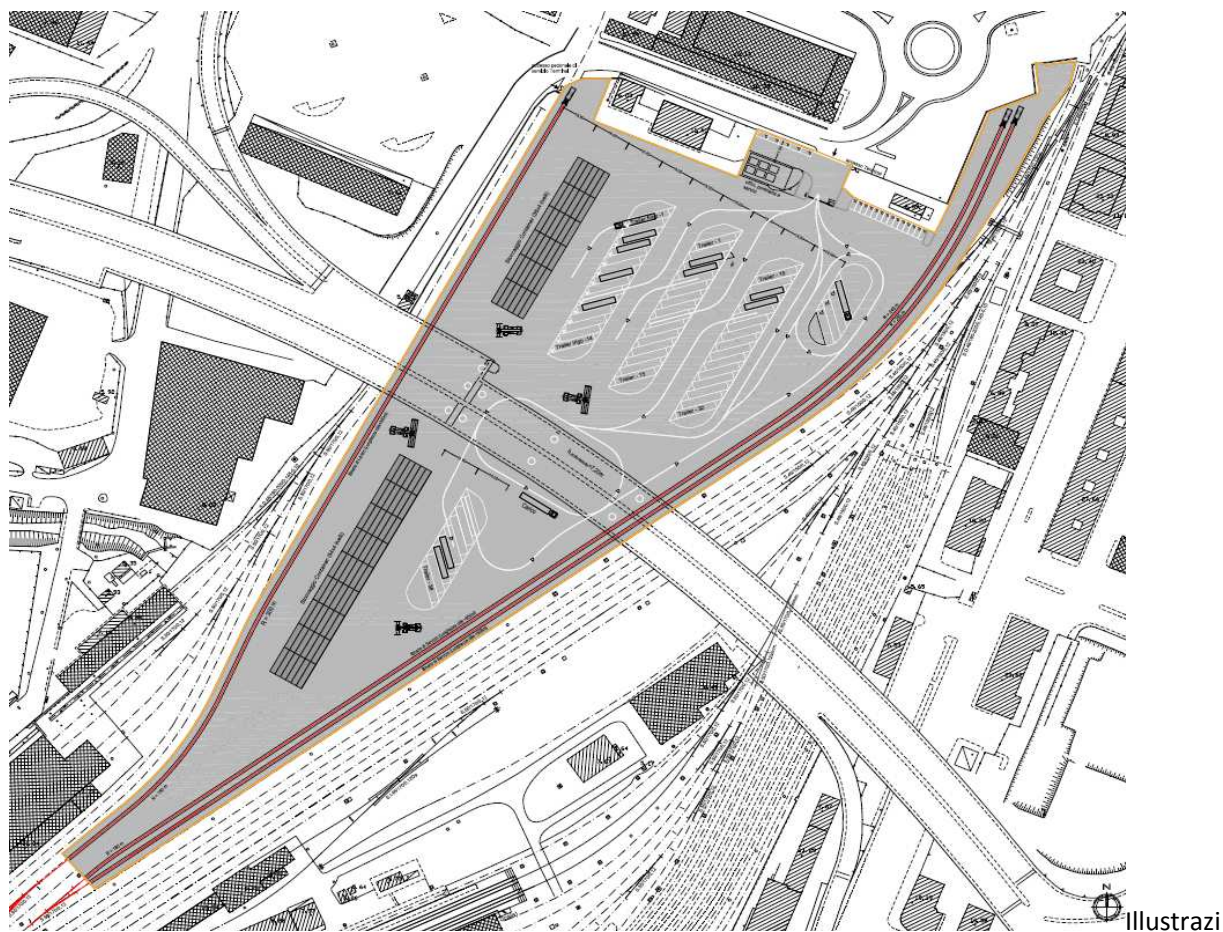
planimetria progettuale dello scalo intermodale Marotti
